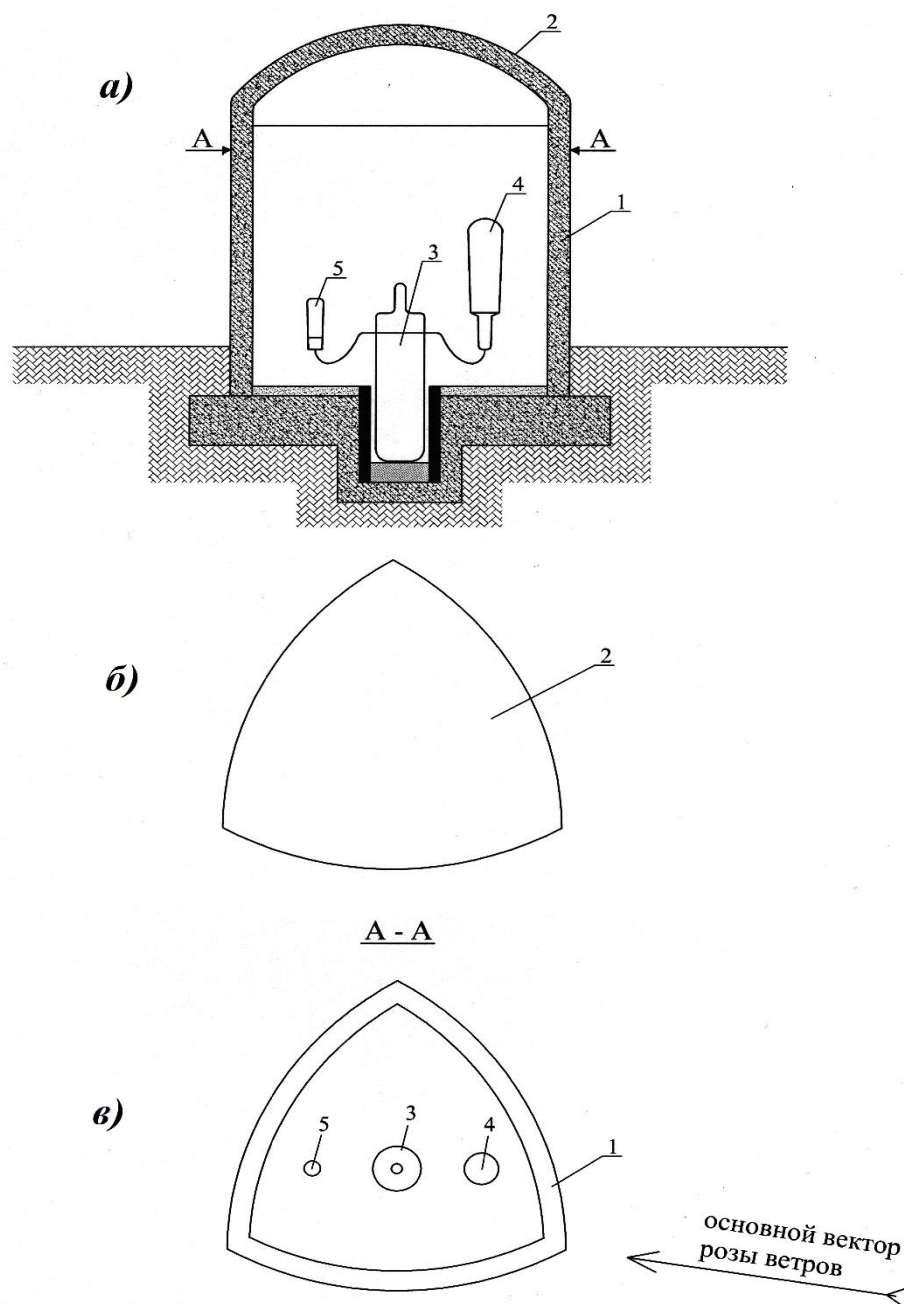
Защитная оболочка реактора АЭС, выполненная в форме треугольника Рело: а) продольный разрез; б) вид сверху; в) поперечный разрез А-А; 1 – стена; 2 – выпуклая крыша; 3 – атомный реактор; 4 – парогенератор; 5 – циркуляционный насос.
